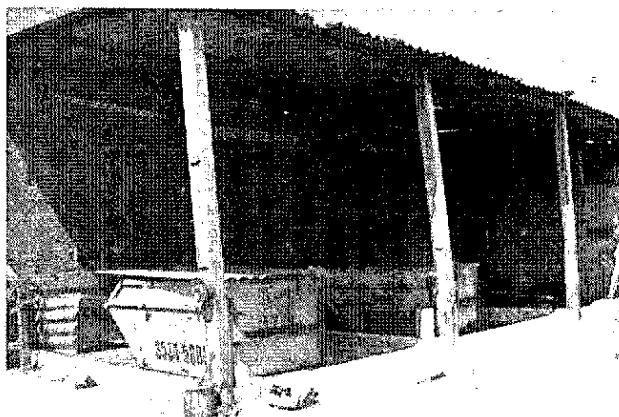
Caçambas para armazenamento do barro das canaletas e caixa SAO.
